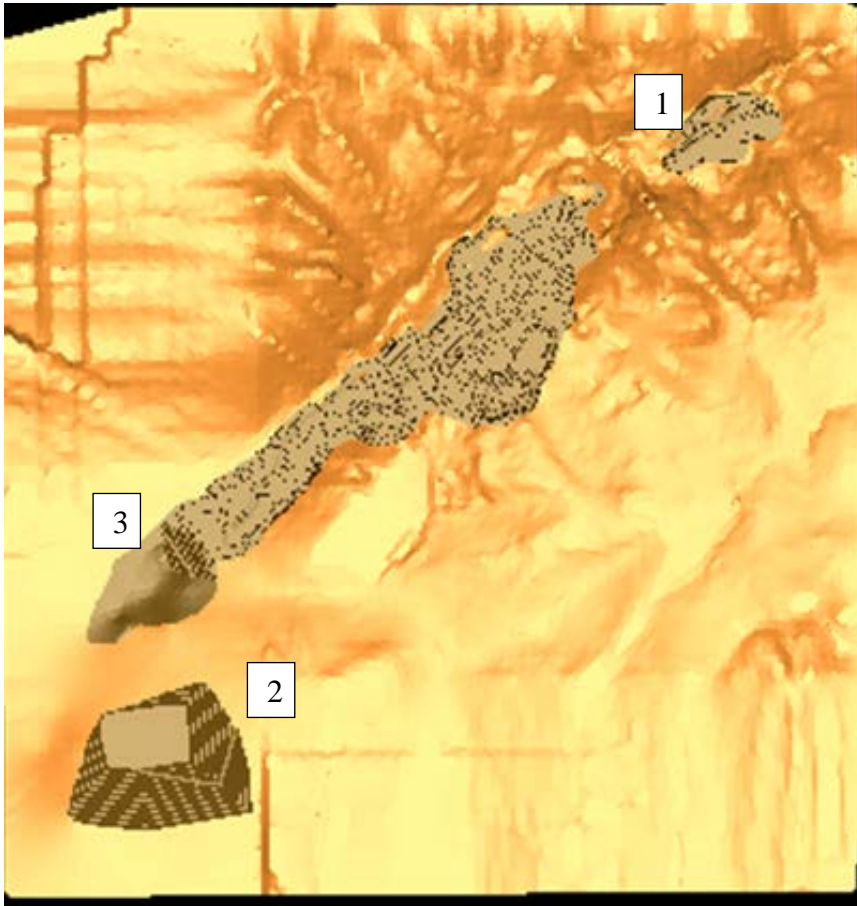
Localização das três pilhas de estéril: pilha 1 ou norte, pilha 2 ou sul e pilha 3 ou externa.
